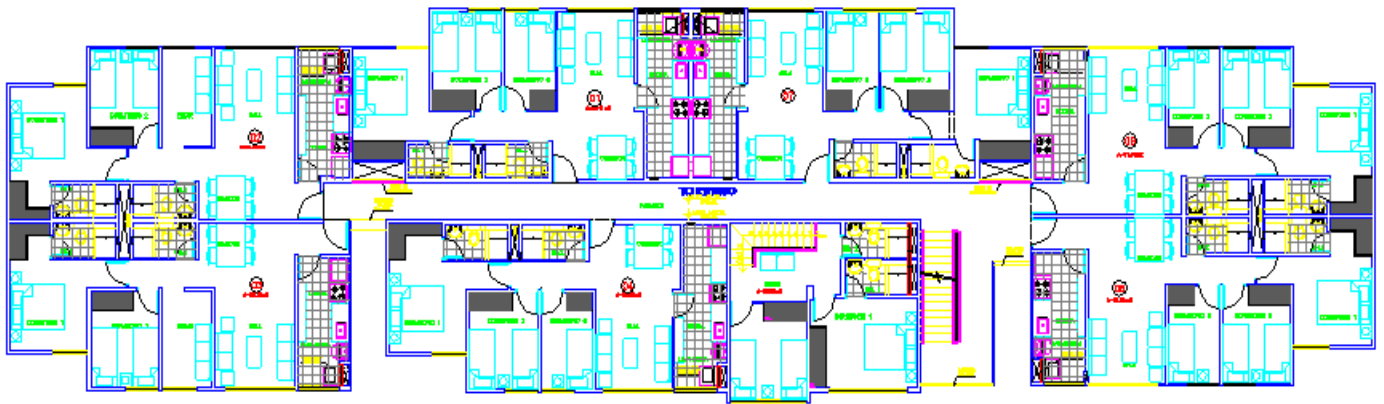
DISTRIBUCIÓN ARQUITECTÓNICA DE TERCERA Y QUINTA PLANTA
